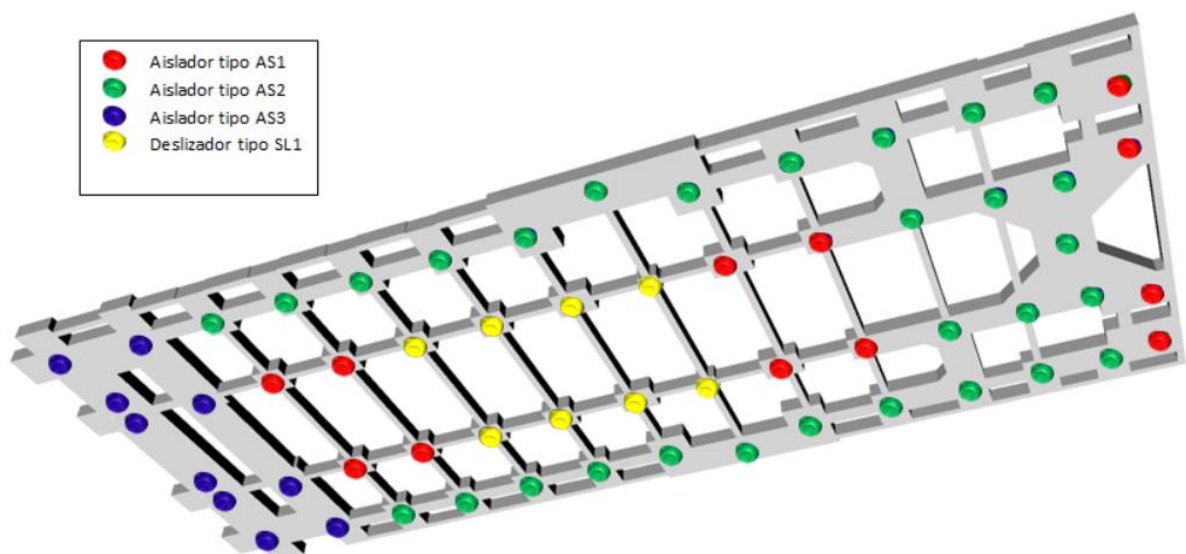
Vista en perspectiva de la distribución de aisladores sísmicos bajo la losa aislada
